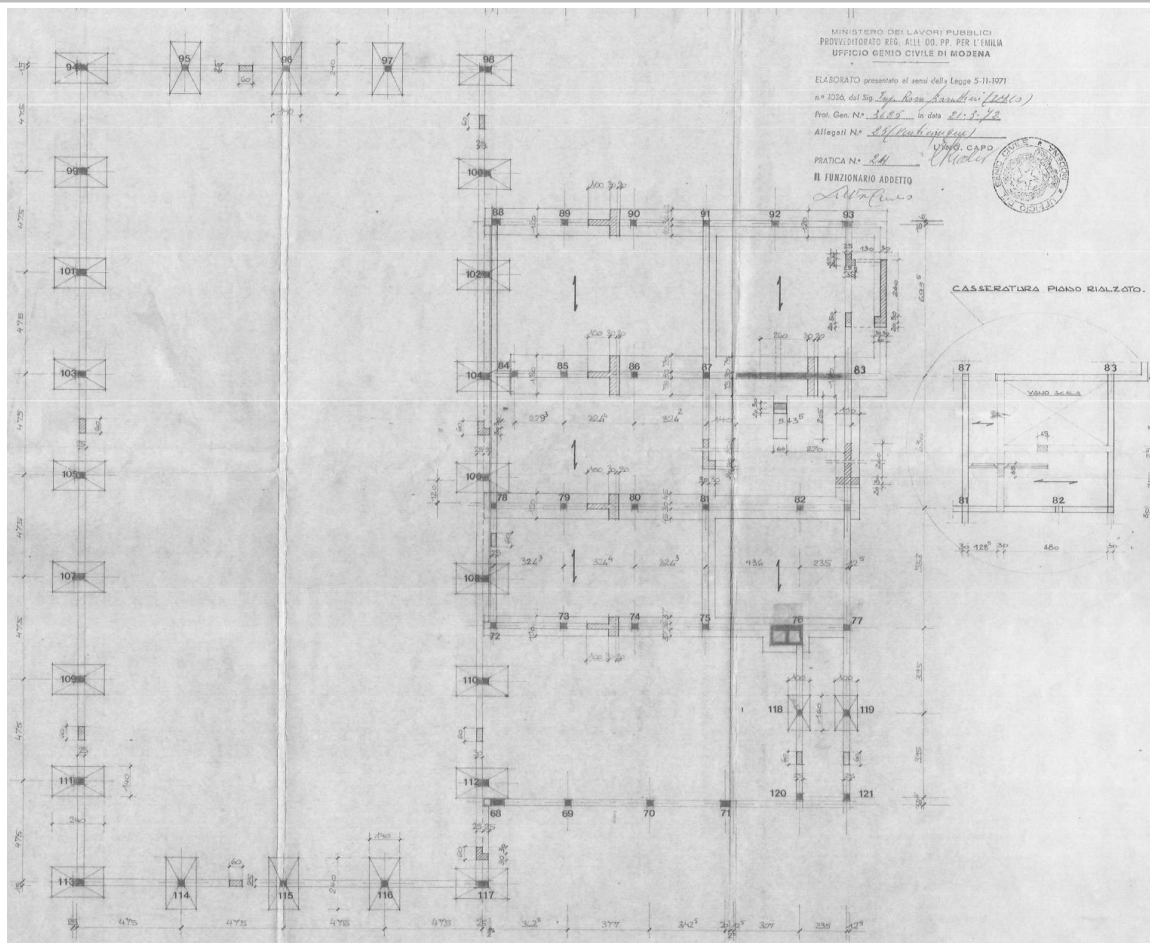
Scuola “A. Fiori” di Formigine – Pianta delle fondazioni della palestra.
